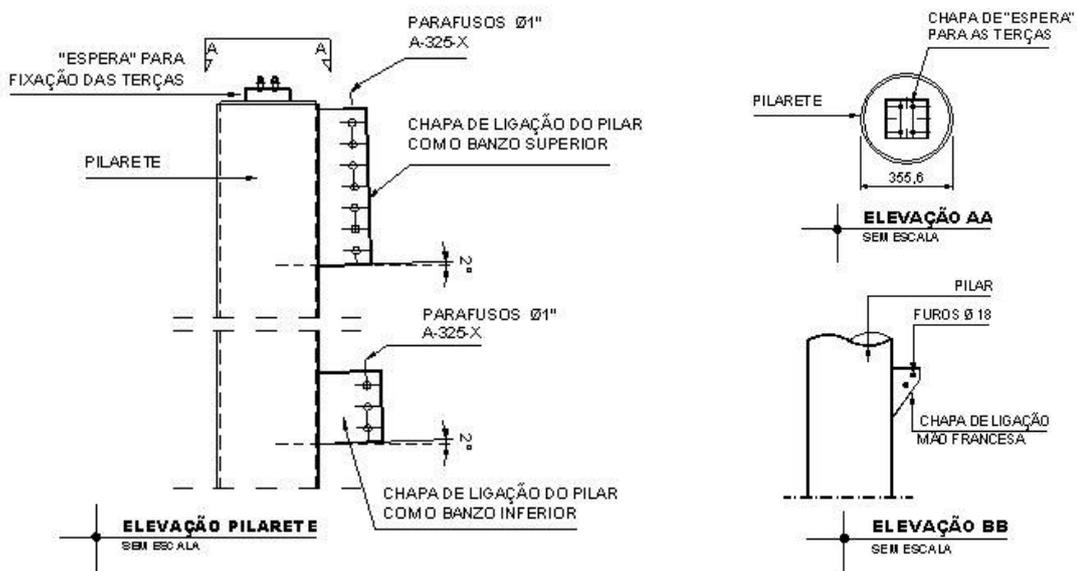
Chapas de ligação soldadas no pilar, detalhe de fixação das terças.
